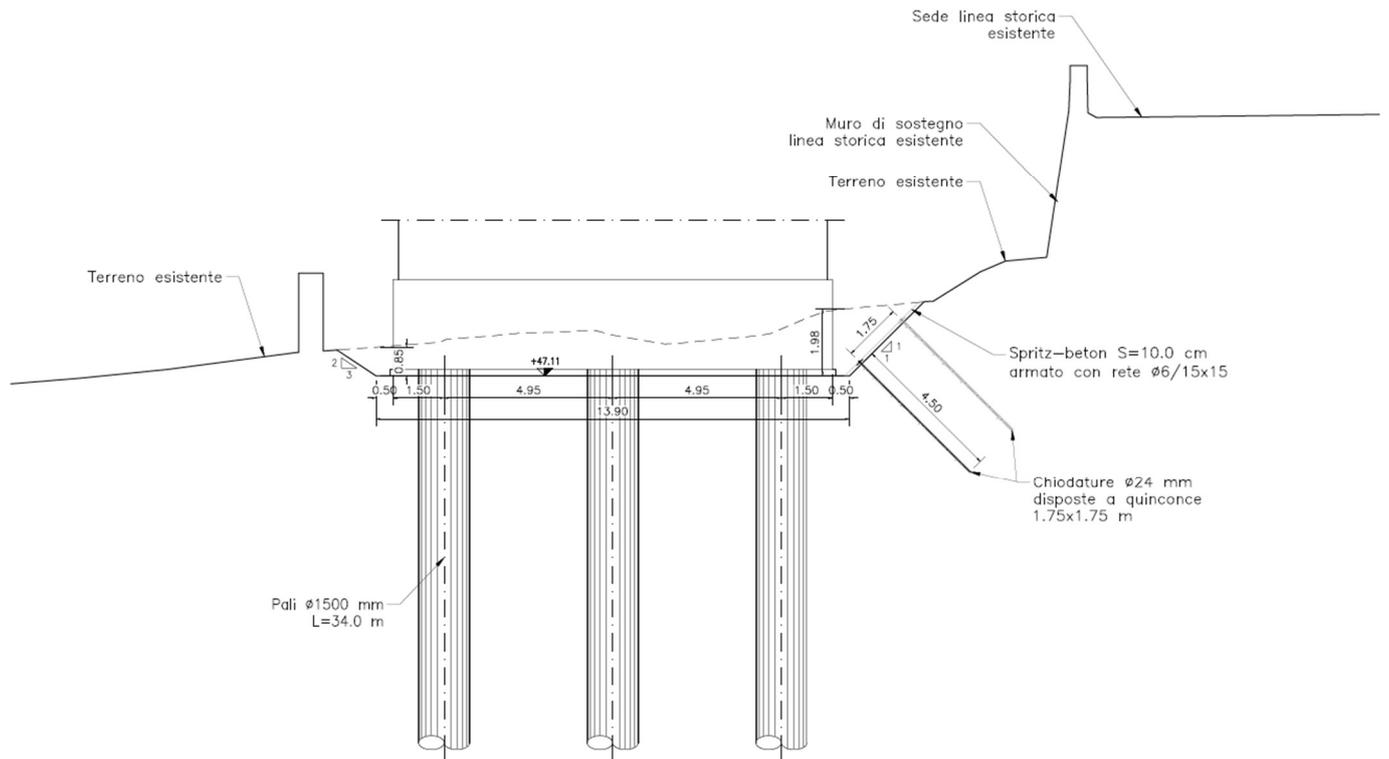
Sezione trasversale scavi per palificata spalla A
